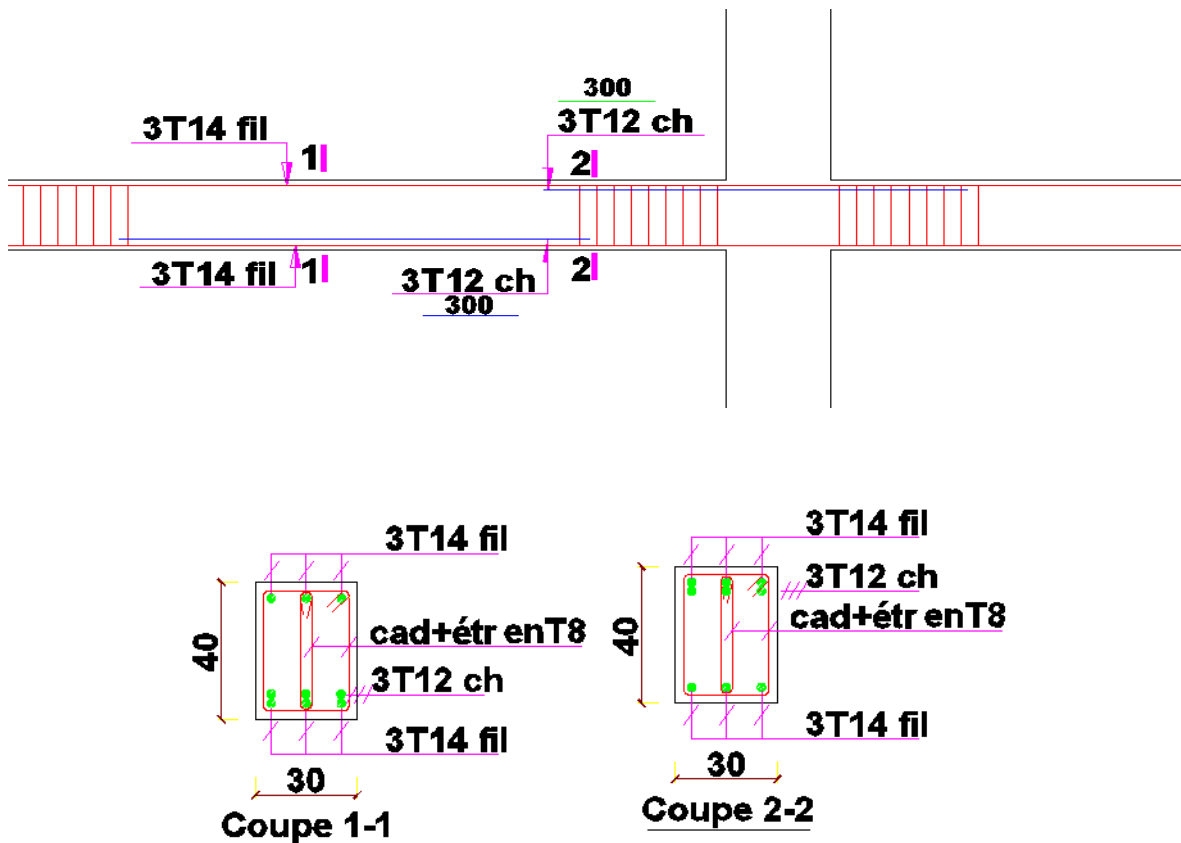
Schéma de ferraillage de poutre secondaire.
